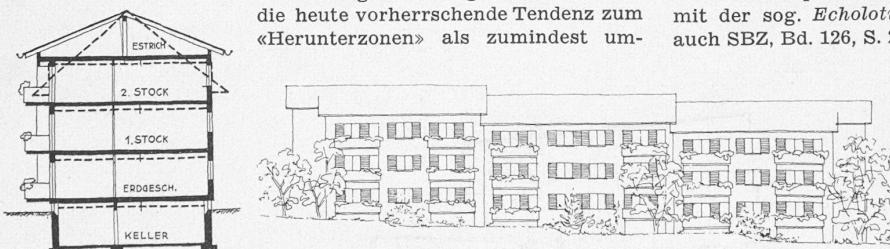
u. 12. Schnitt und Ansicht einer Bebauung mit drei Vollgeschossen und nicht ausgebautem Dachstock. Gestrichelt: Schnitt der ausgeführten Bauten mit ausgebautem Dach
